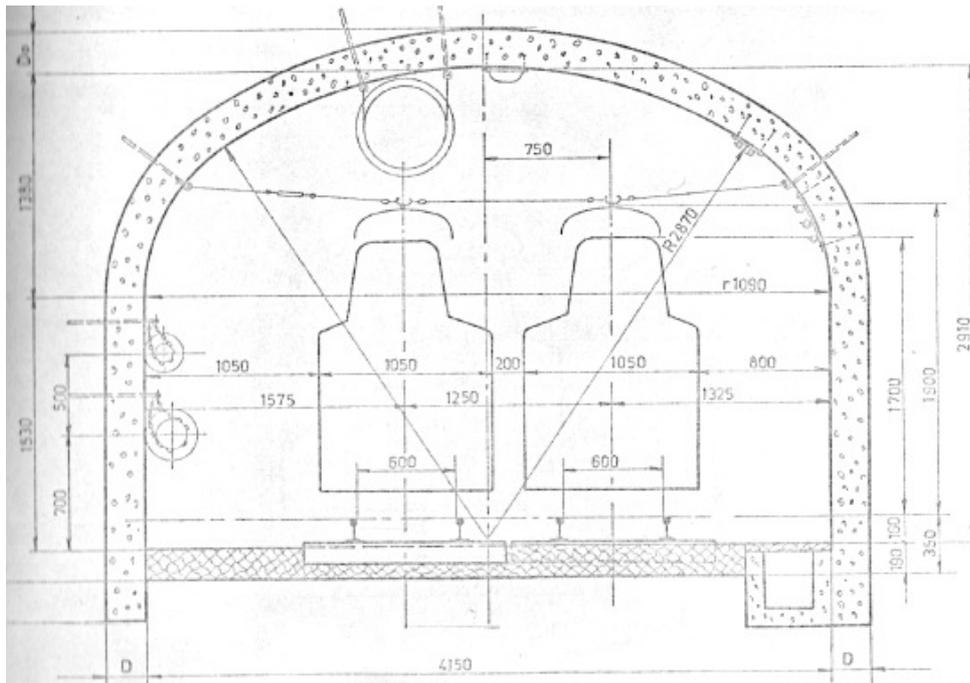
Stollen mit Betonsicherung mit zwei Gleisen in einer geraden Strecke
